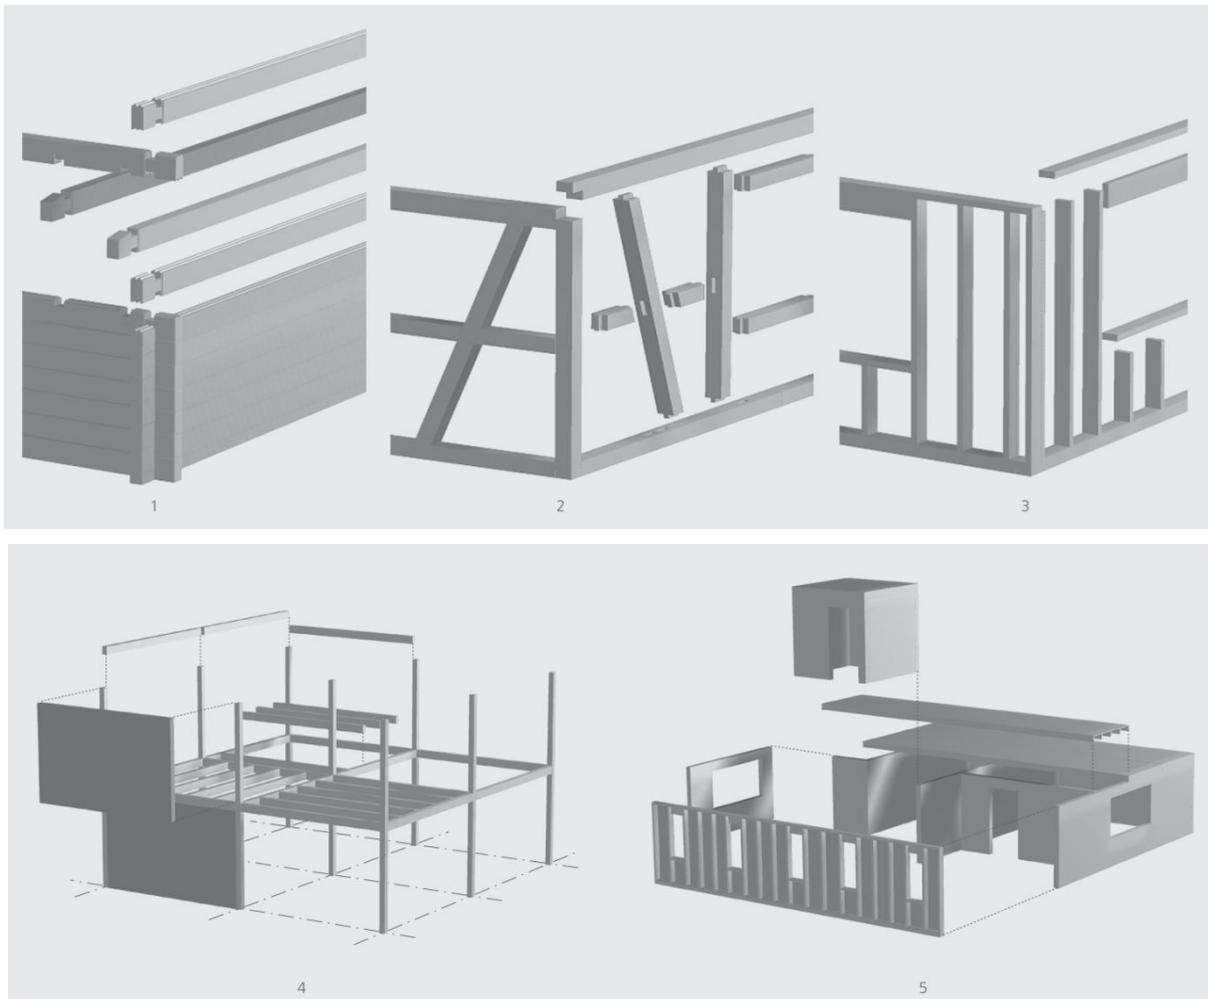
Fertigungstiefe im Vergleich der einzelnen Holz-Bausysteme (1 Blockbau, 2 Fachwerkbau, 3 Ständerbau (Balloon-Frame, Platform-Frame), 4 Skelettbau, 5 Rahmenbau) [1]
